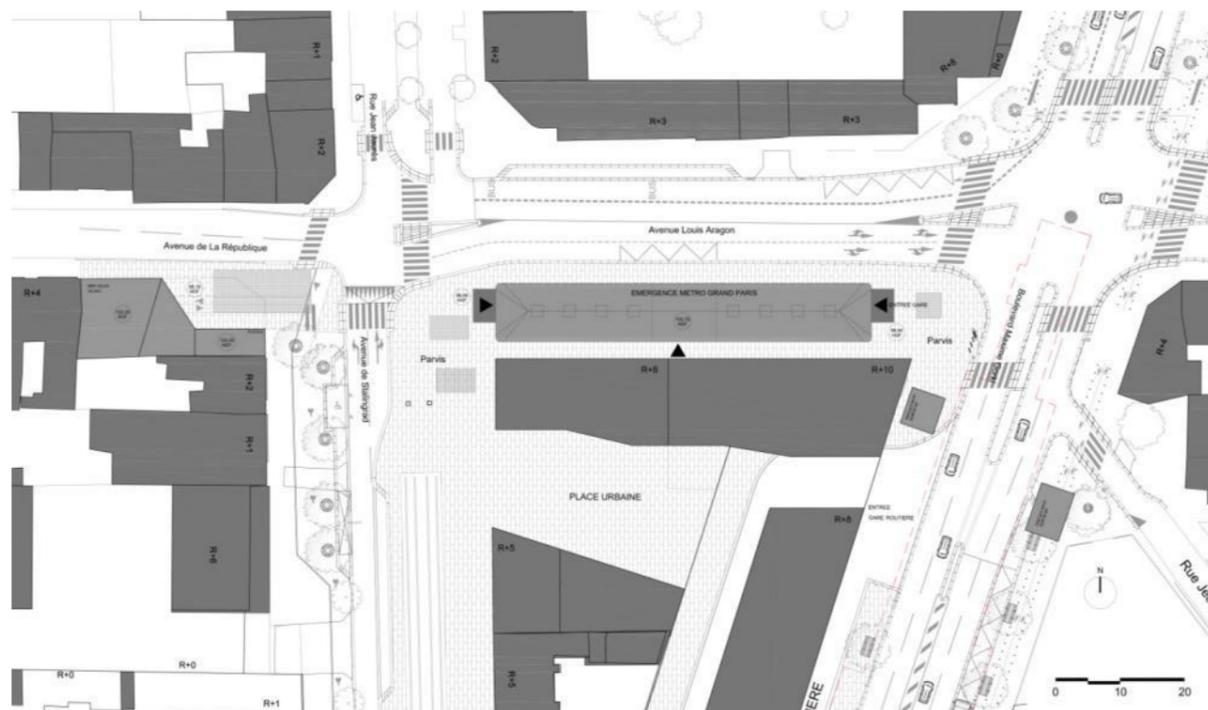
Gare de Villejuif Louis Aragon - Plan d'implantation
